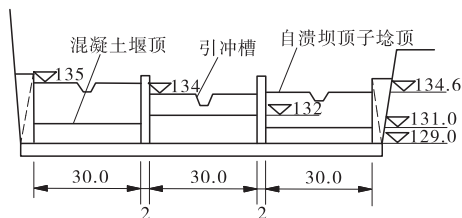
引冲自溃式非常溢洪道 (单位:m)
